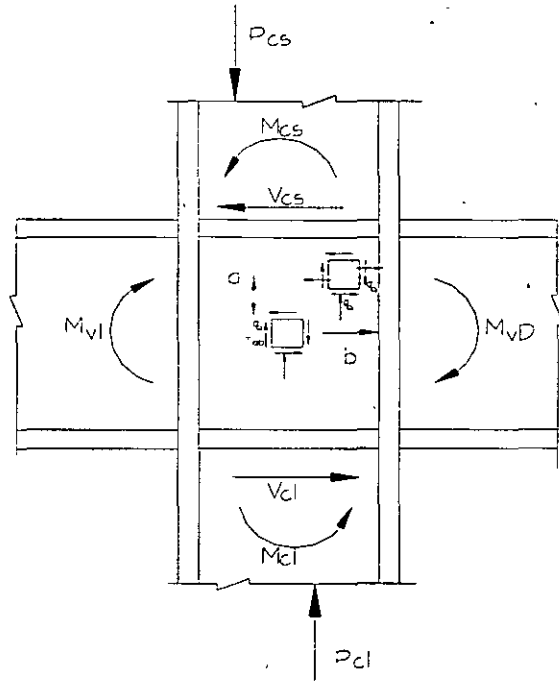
Esfuerzos en el alma de la columna en una junta
